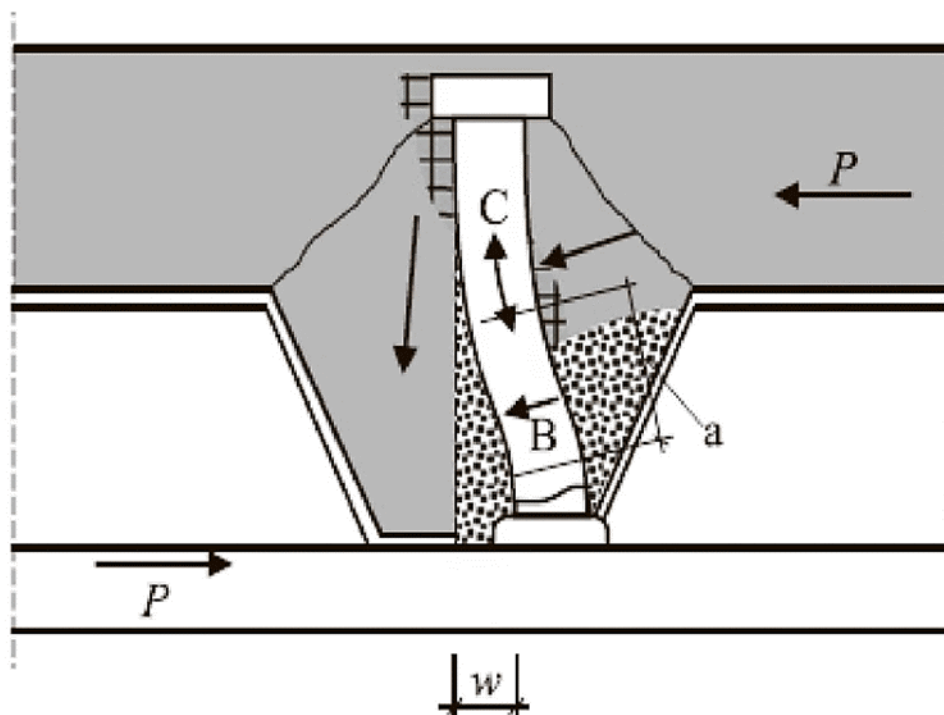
Модель Лунгерсхаузена для опису НДС стержневого анкерного упору у складі сталезалізобетонного перекриття з плитою, яка влаштована по незнімній опалубці із сталевому профільованому настилу
